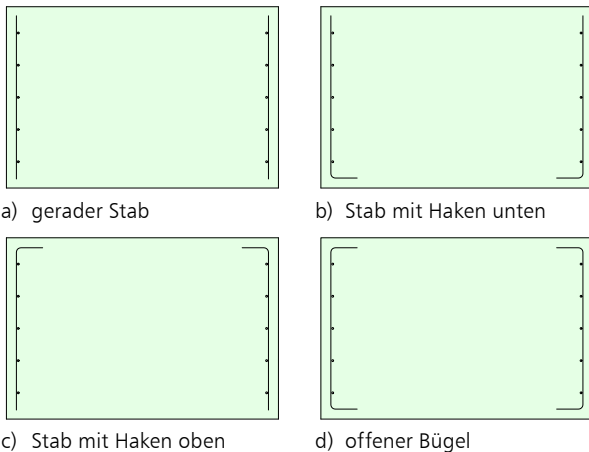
Stabstahl Bügelform – seitlich vertikale Bewehrung
